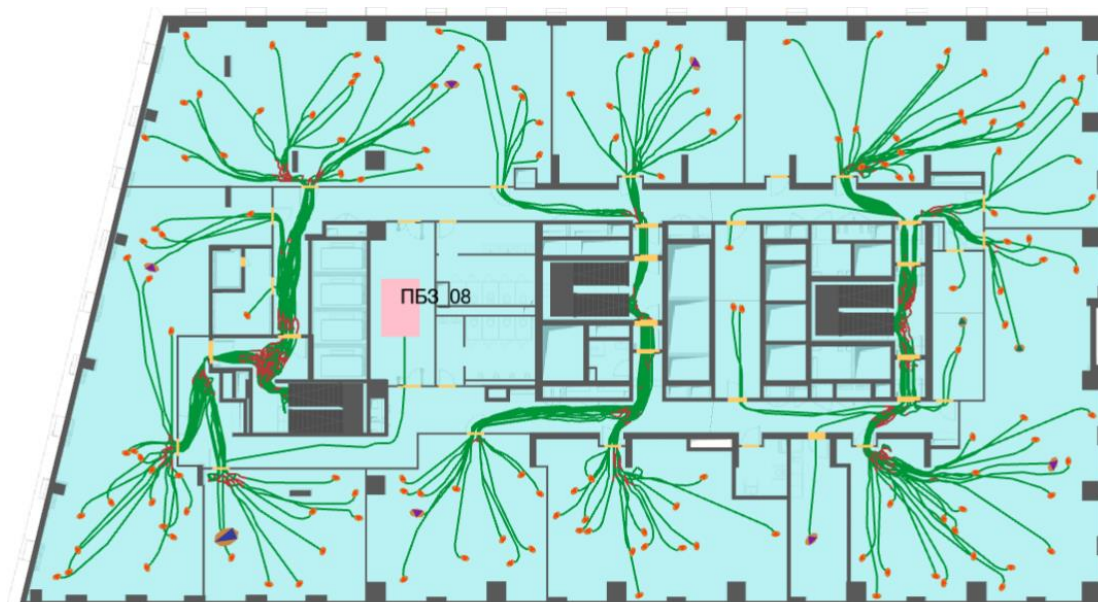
План 8-го этажа и нанесенная на него расчетная (принципиальная) схема эвакуации
